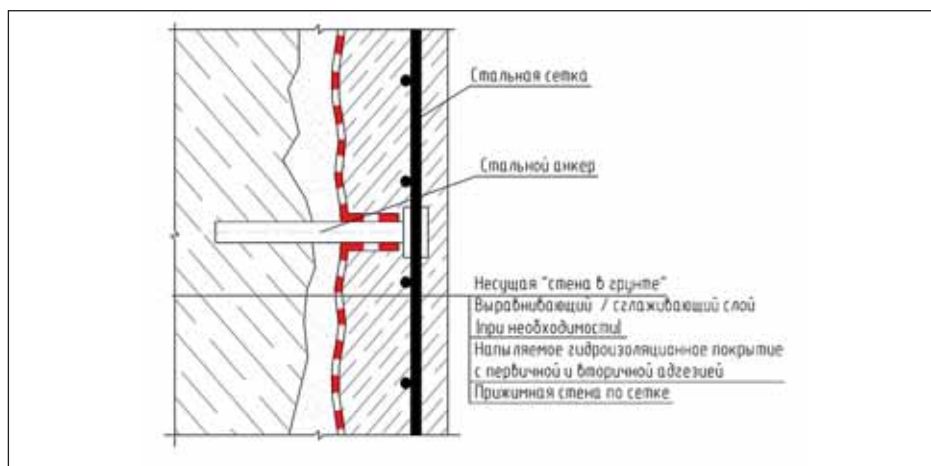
Устройство гидроизоляционной системы при открытом способе работ с использованием «стены в грунте» в качестве несущей. Узел 3
